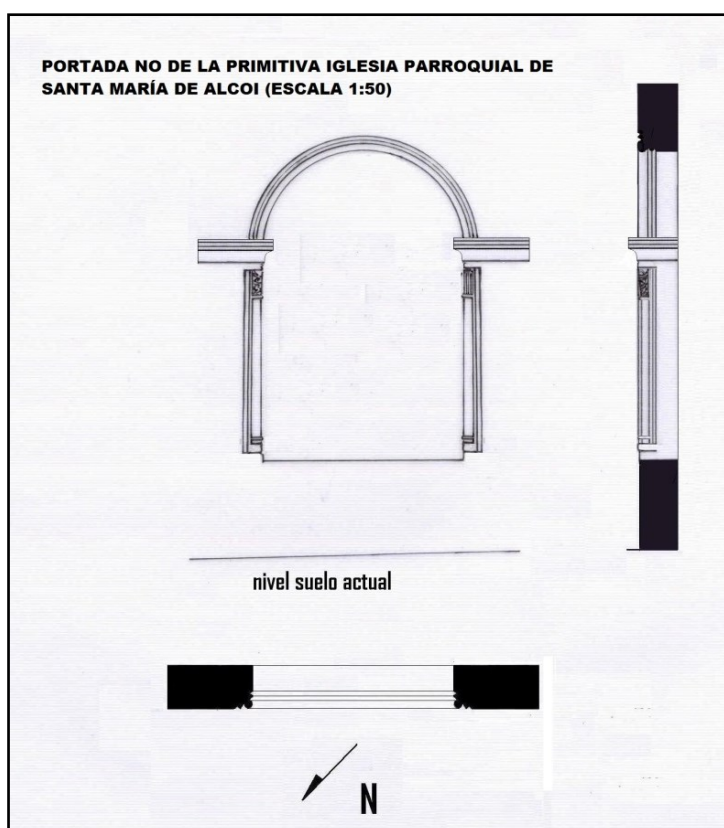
Reconstrucción de la portada NO en planta, alzado y sección, a escala 1:50 (Francisco J. Soriano).
